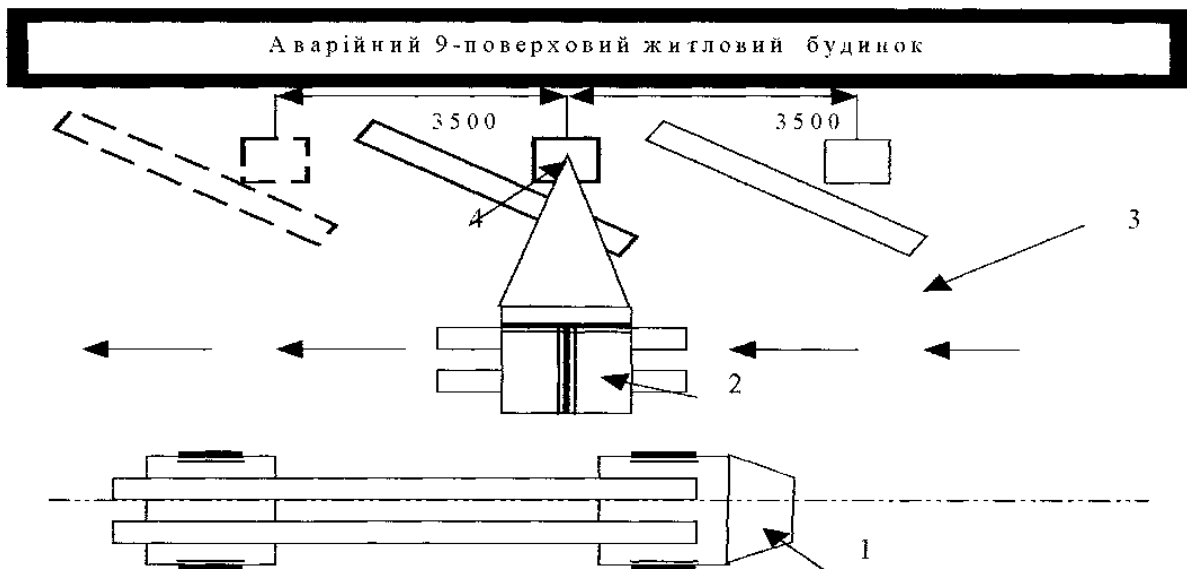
Транспортування і розкладка на місці монтажу пальового фундаменту: 1 - спецмашина для перевезення паль, 2 - кран для розвантаження і розкладки паль на місці монтажу, 3 - площадка, 4 - монтаж паль.
